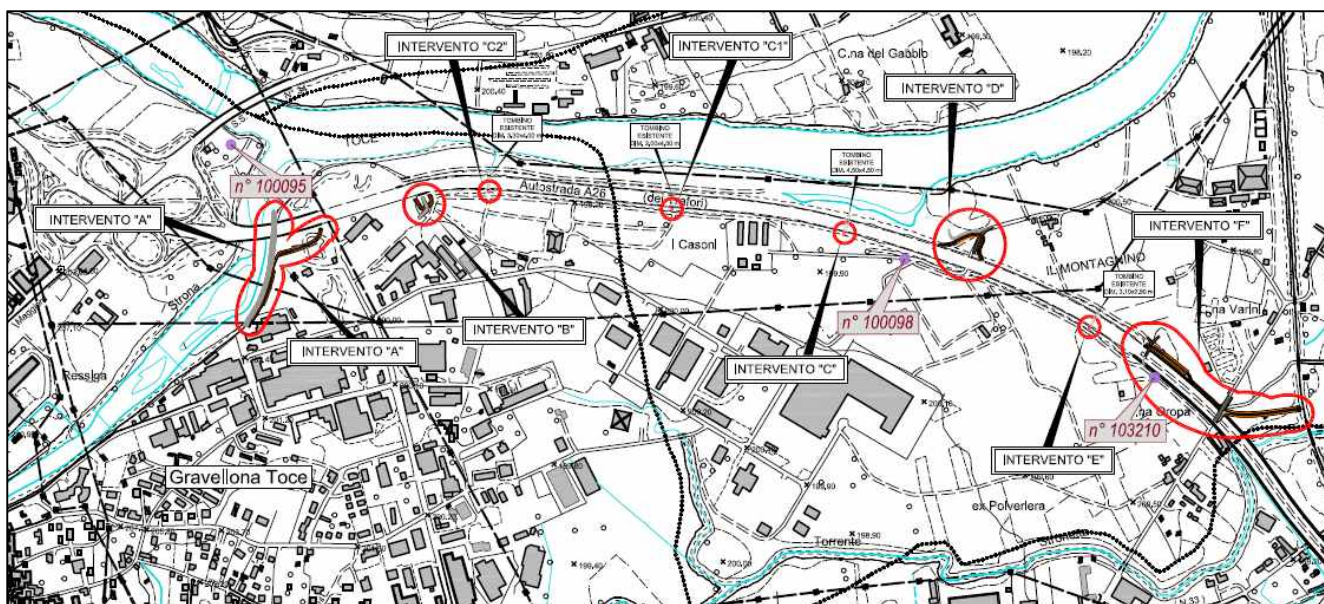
Localizzazione sondaggi. Estratto da “Planimetria di progetto con indicazione sondaggi” - Stralcio
